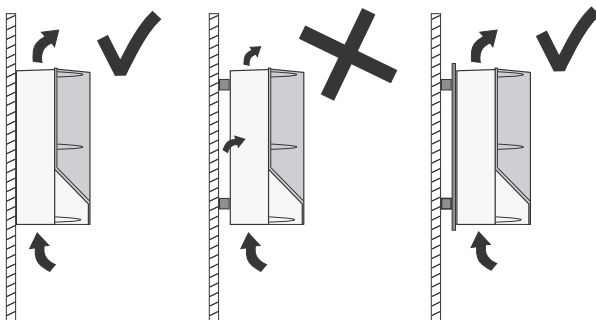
CUE posé directement sur mur ou fixé avec une plaque arrière.
